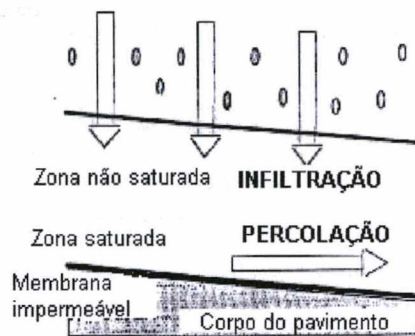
Drenagem e infiltração em pavimento drenante molhado (GNCSC, 1996)
